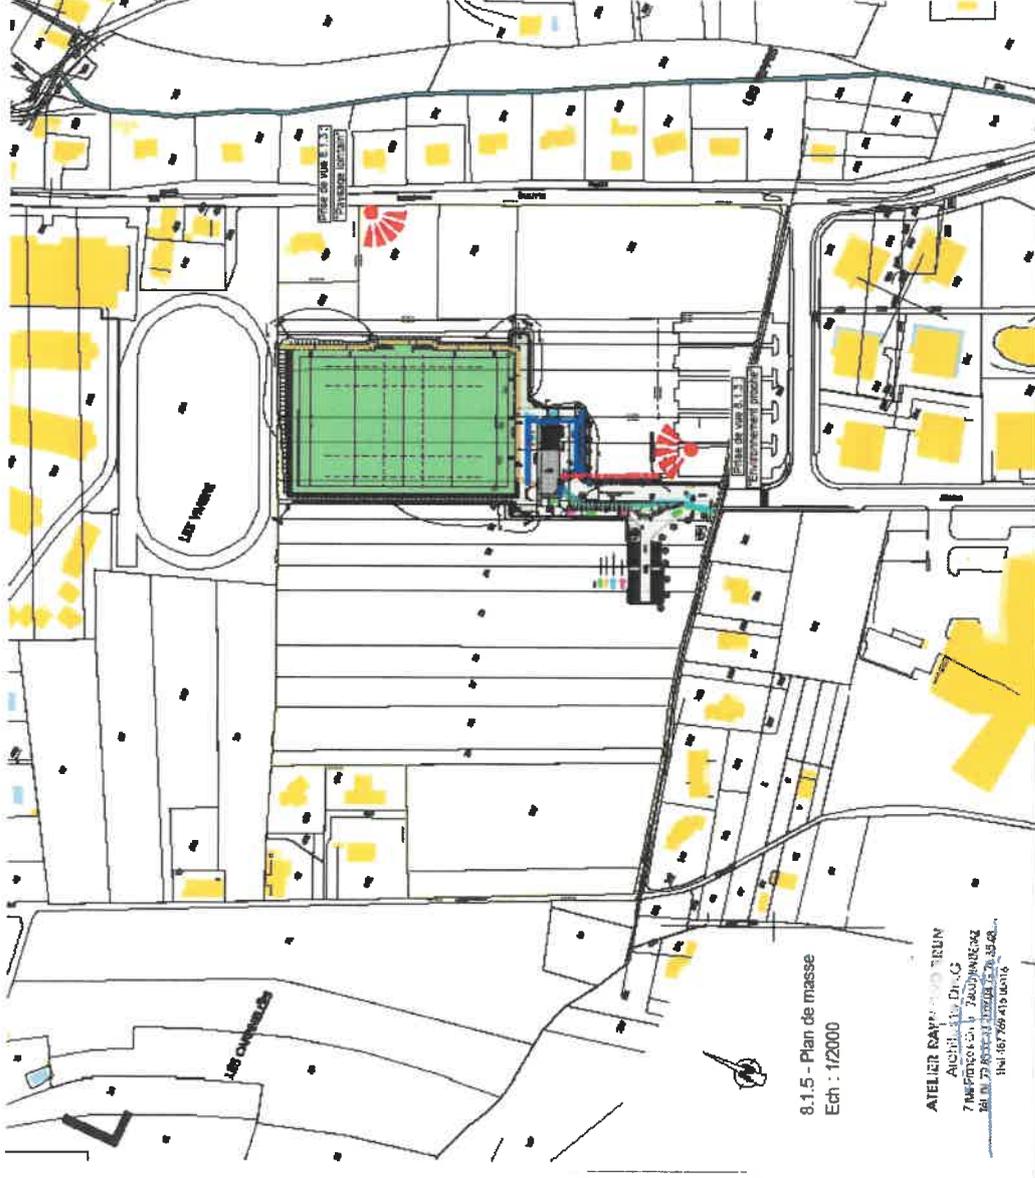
Plan de masse (Source : Atelier Raymond Brun Architecte)
